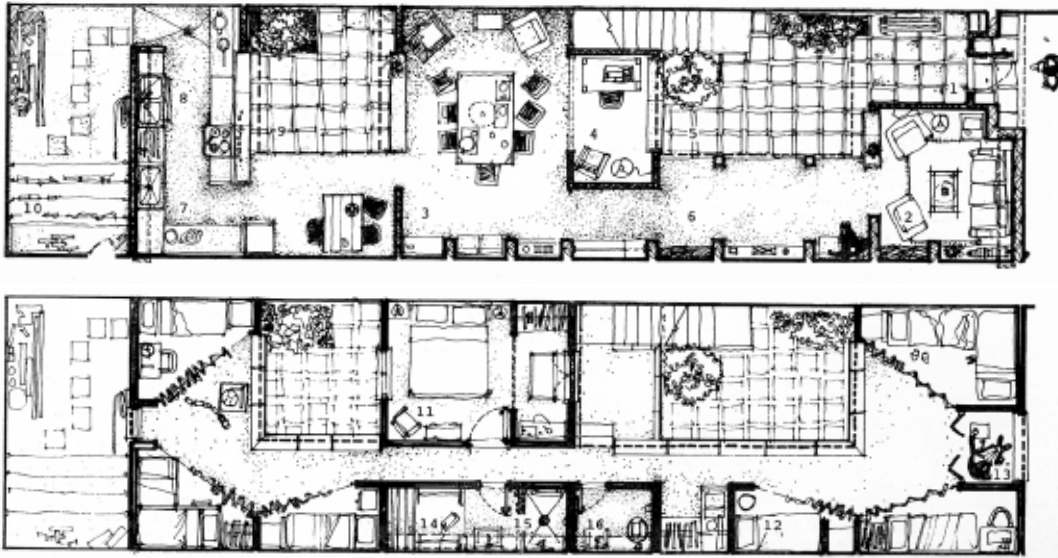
Planta baja y primer piso de una de las viviendas posibles.
